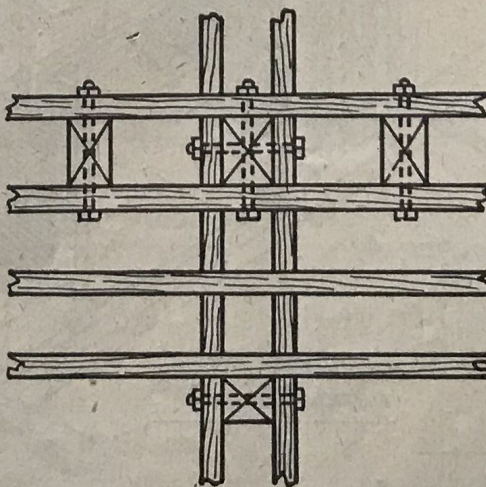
Ensemble d'un montage de plancher sur poteaux continus, vu en plan.
